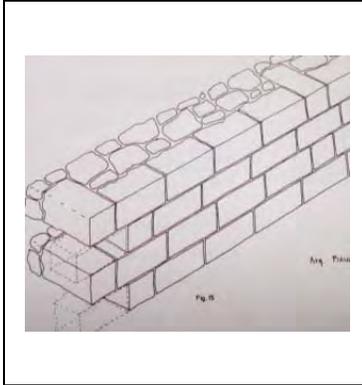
Muro compuesto por sillares y piedra irregular de cantería.
